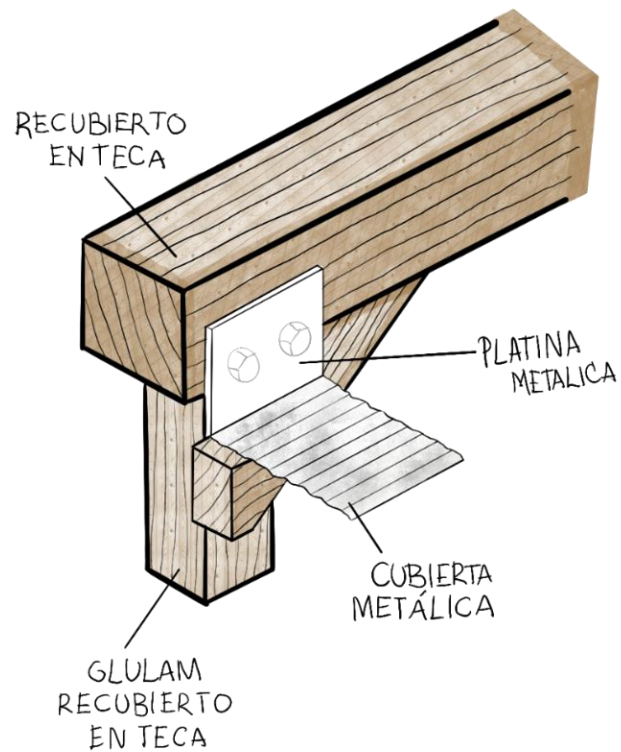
Detalle constructivo de la estructura con base a la información extraída anteriormente- Autoría propia
